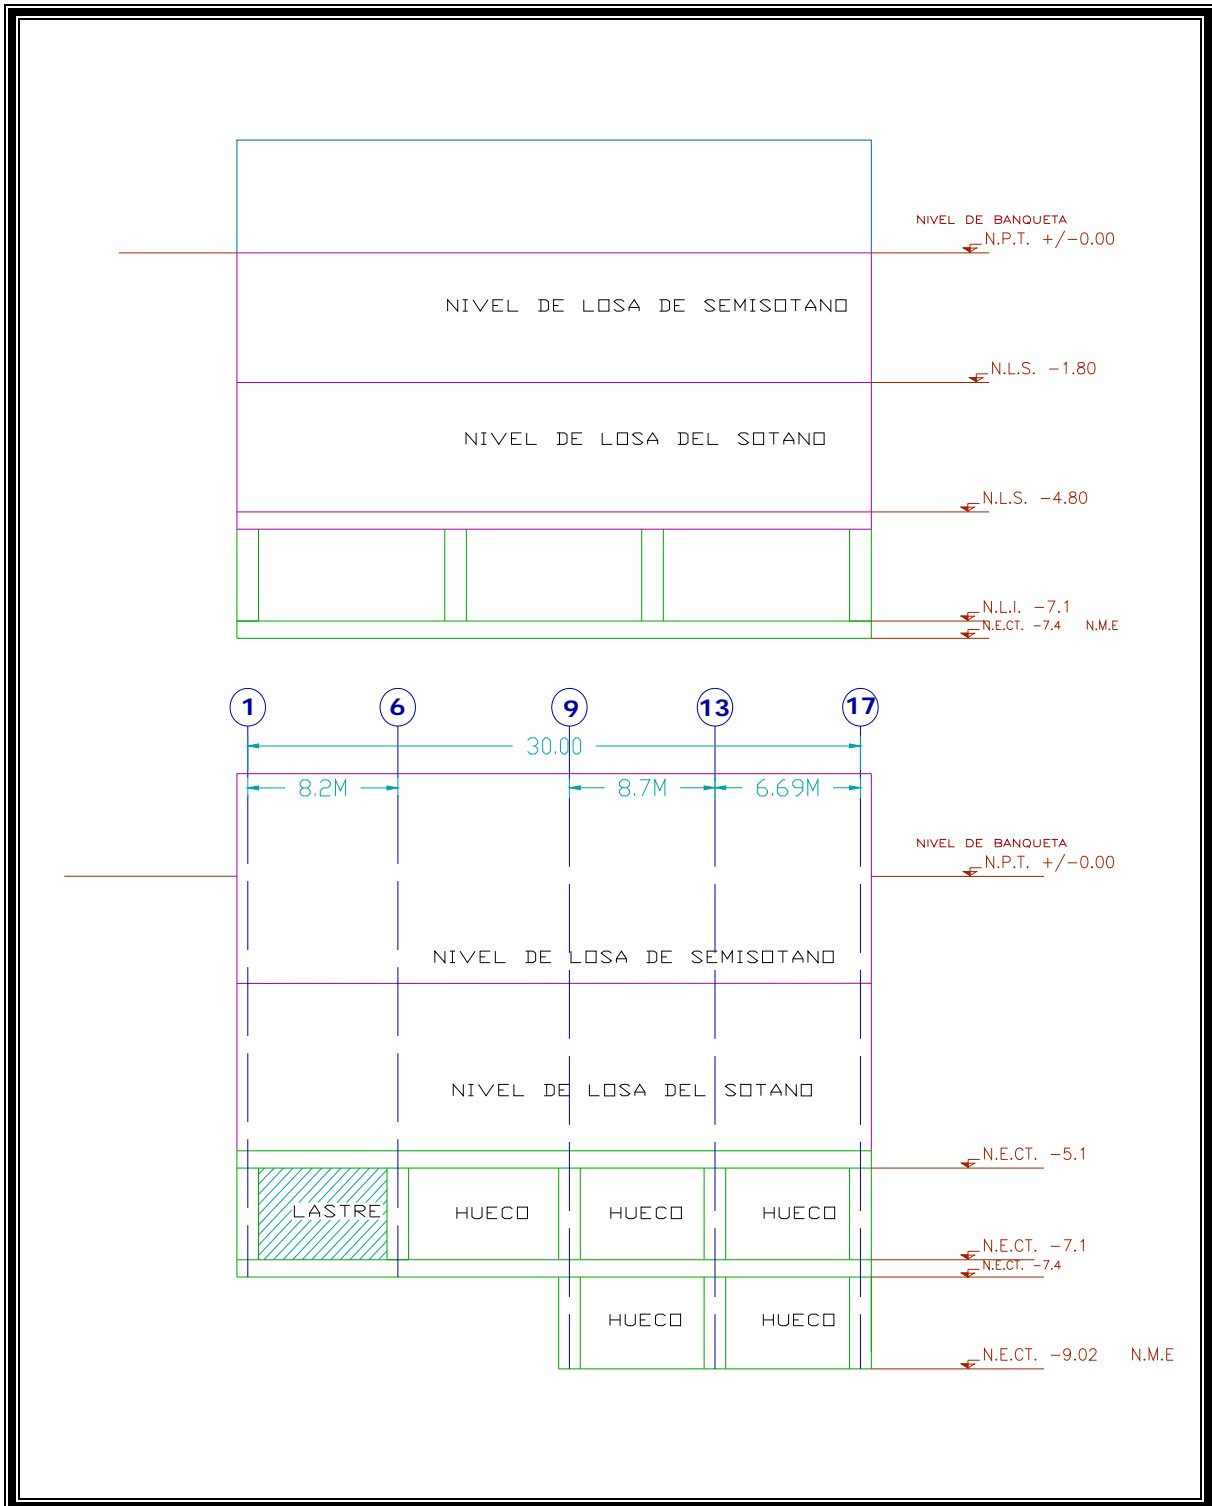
CAJÓN DE CIMENTACIÓN COMPENSADO TOTALMENTE, CON DIFERENTES DESPLANTES Y CON LASTRE
